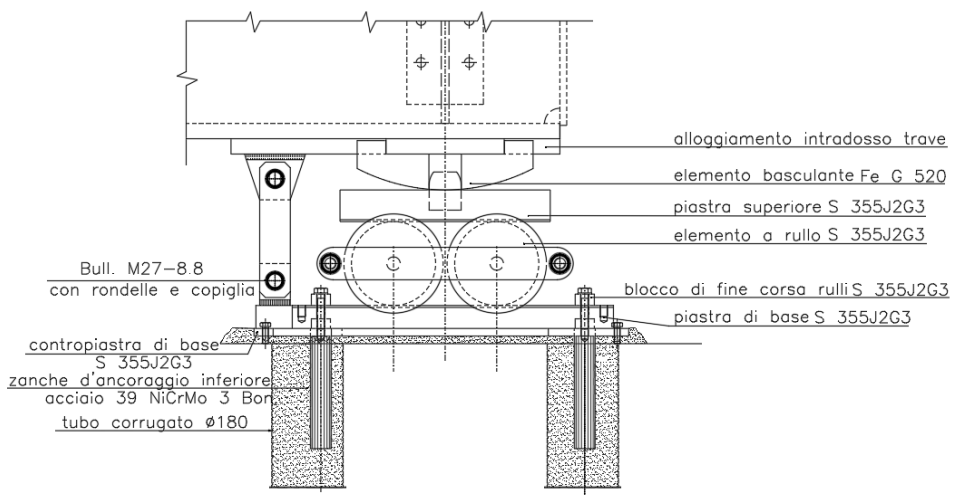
Sezione longitudinale dispositivi di appoggio unidirezionali
